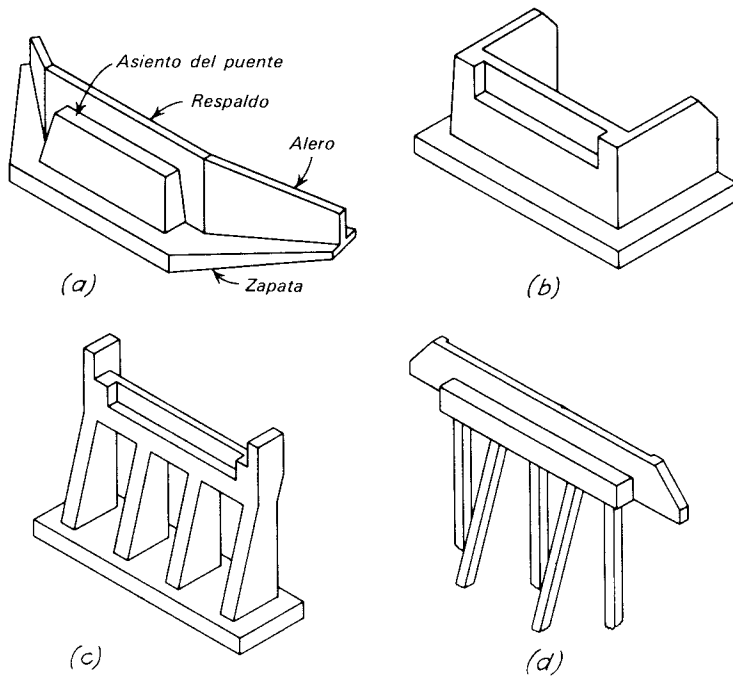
Tipos de estribos. a) Estribo típico de gravedad con aleros. b) Estribo en U. c) Estribo sin muro ni aleros. d) Estribo de caballete con aleros cortos en el cabezal.
